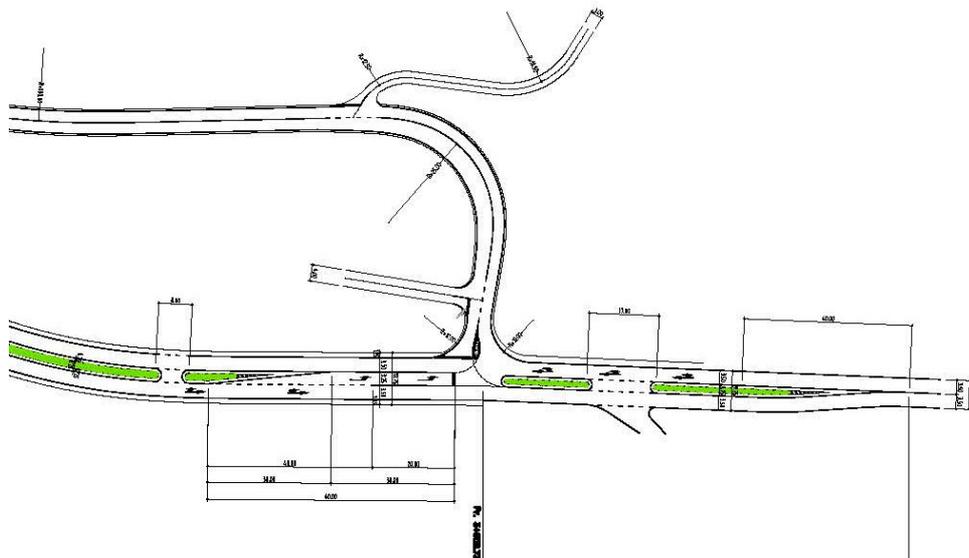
Dimensionamento corsie intersezione con viabilità locale
